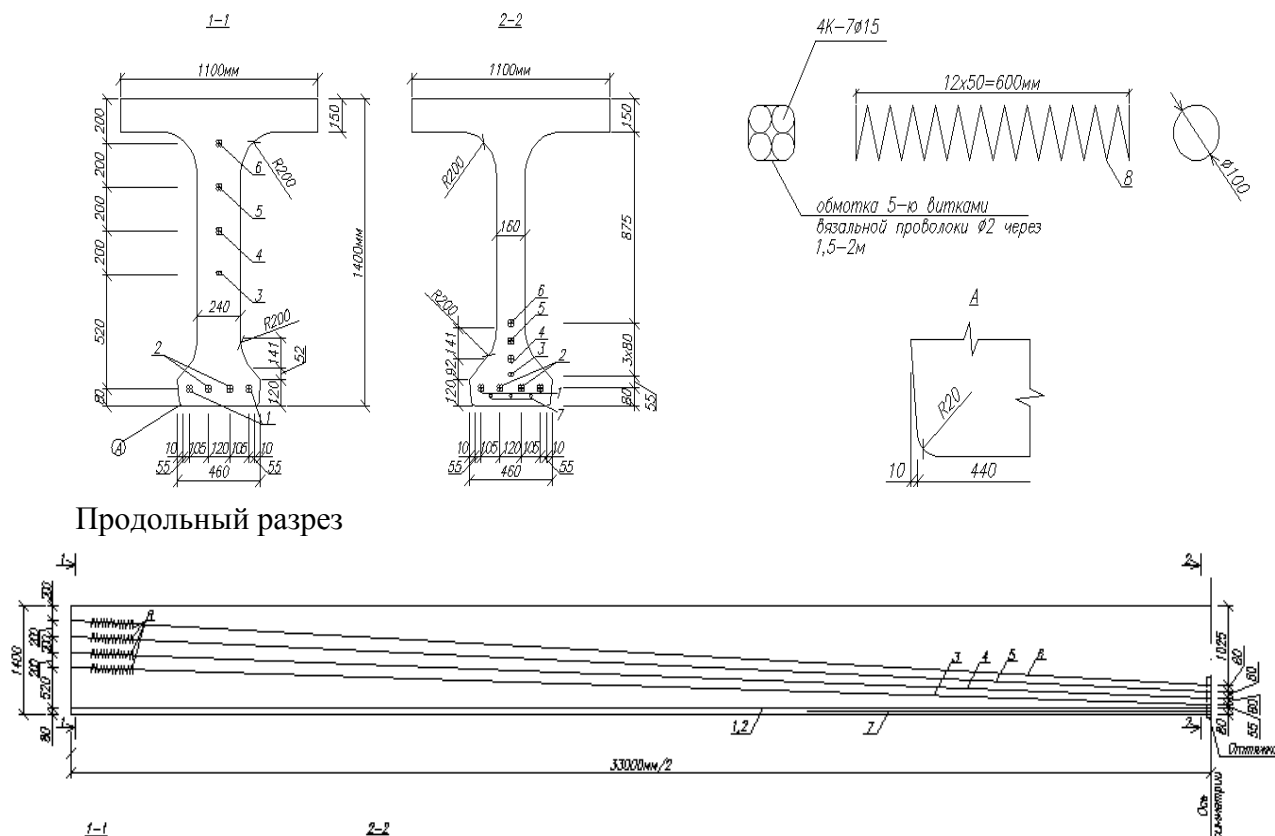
Продольный разрез, поперечные сечения балок в торце, в середине пролета и данные по их армированию
